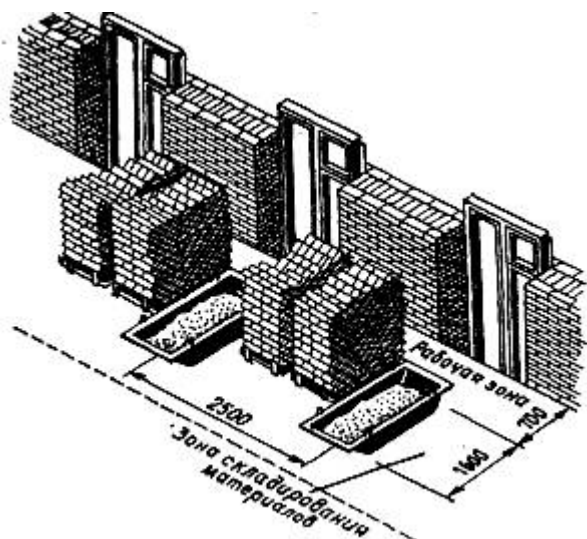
Типовая схема размещения материалов на рабочем месте при кладке стен с проемами
